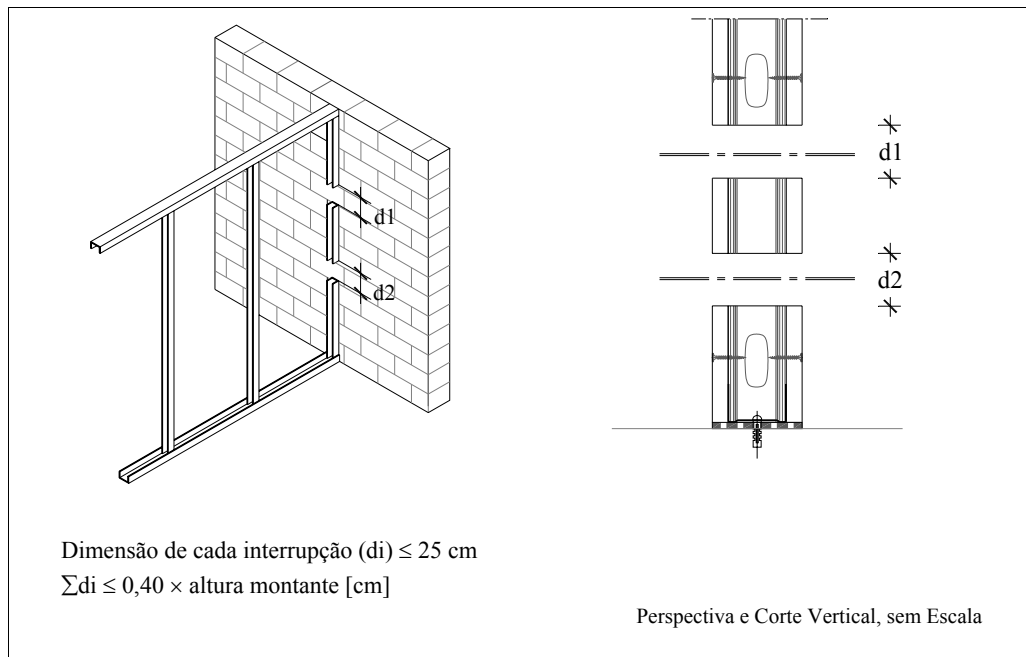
Pormenorização da interrupção de montantes perimetrais [47]
